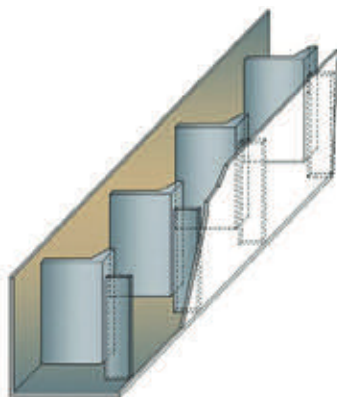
Imagem dos septos e ranhuras verticais da escada. Fonte: da autora
